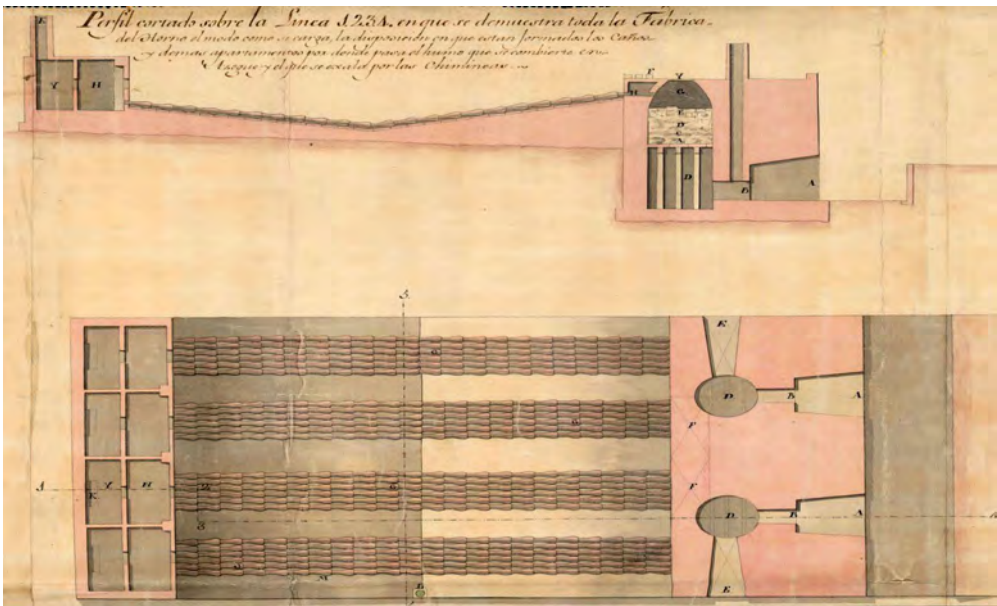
Centro Geográfico del Ejército. Planos, Ciudad Real n.º 244. Detalle del alzado y la planta de los hornos de aludeles
